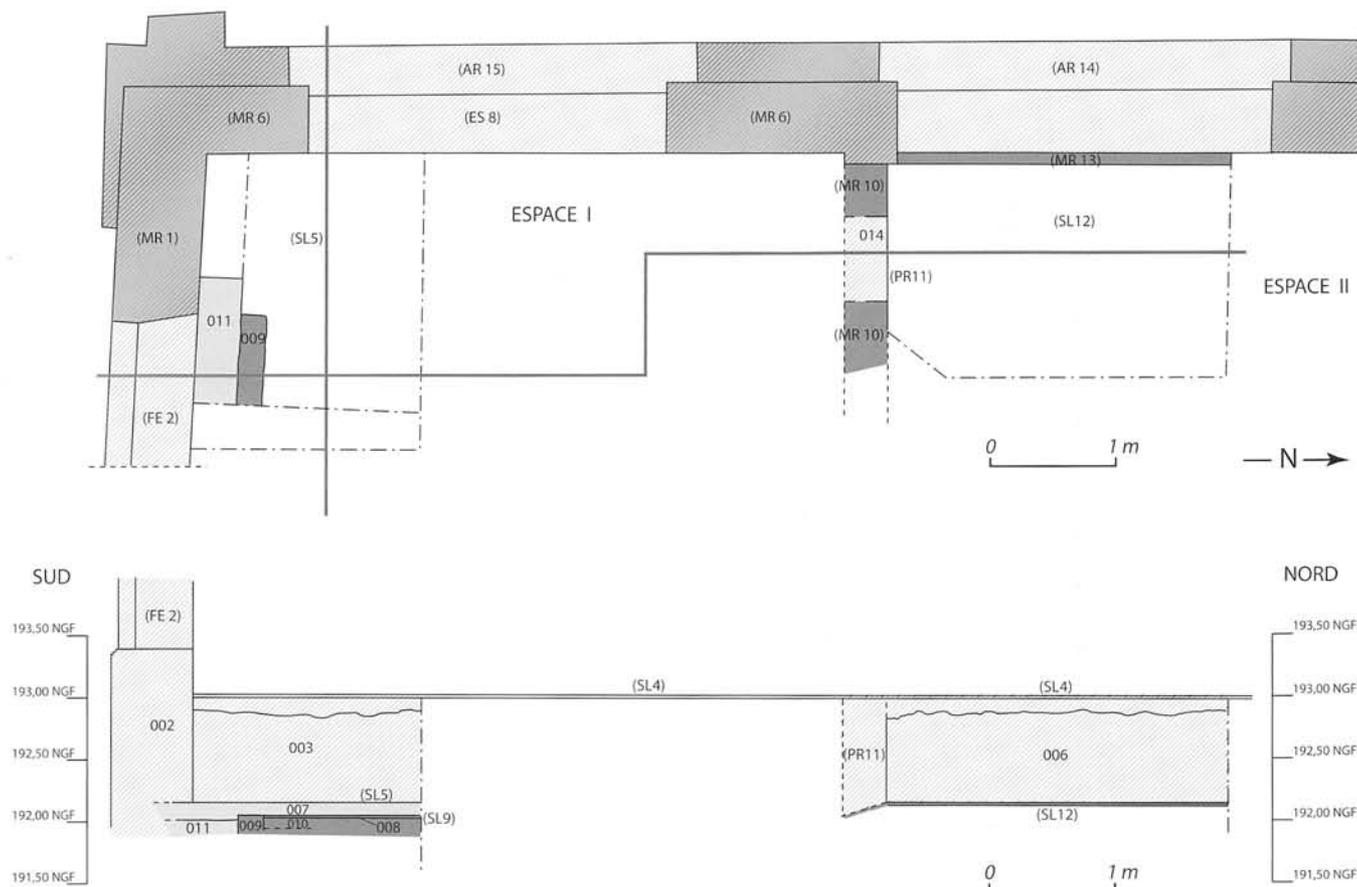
AIX-EN-PROVENCE, hôtel Boyer d'Éguilles. Aile est, sondages 1 et 2 : plan et section des vestiges (DAO M. Panneau).
